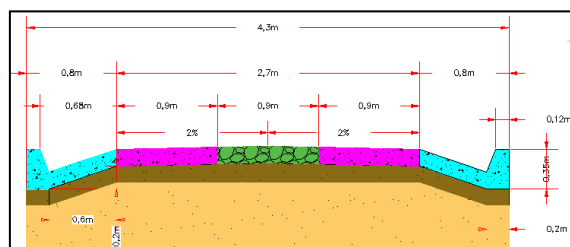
Sección transversal de placa-huella entre abscisas K0+182 m y abscisa K0+132 m.
